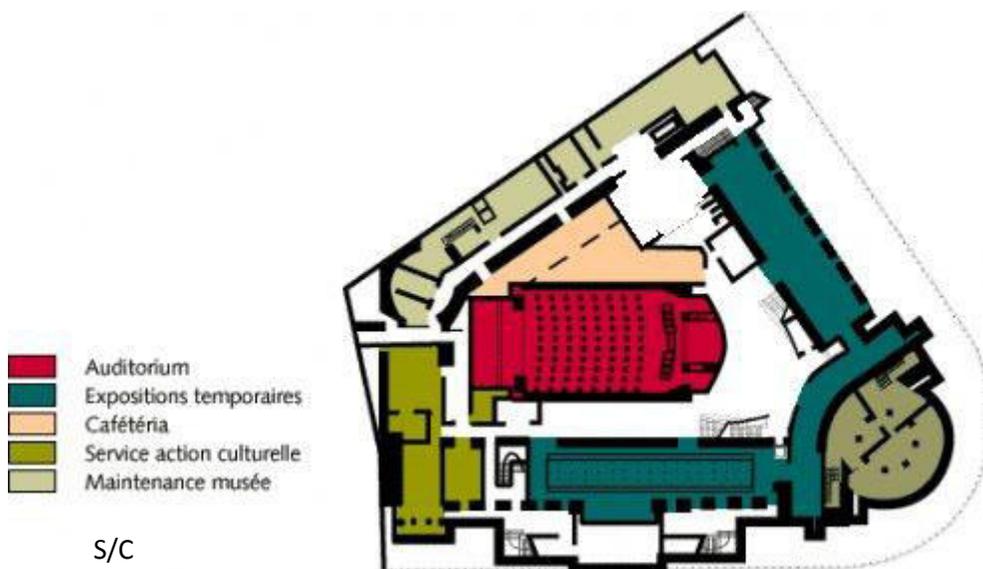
Plano planta baja del Museo Guimet, París Francia.
